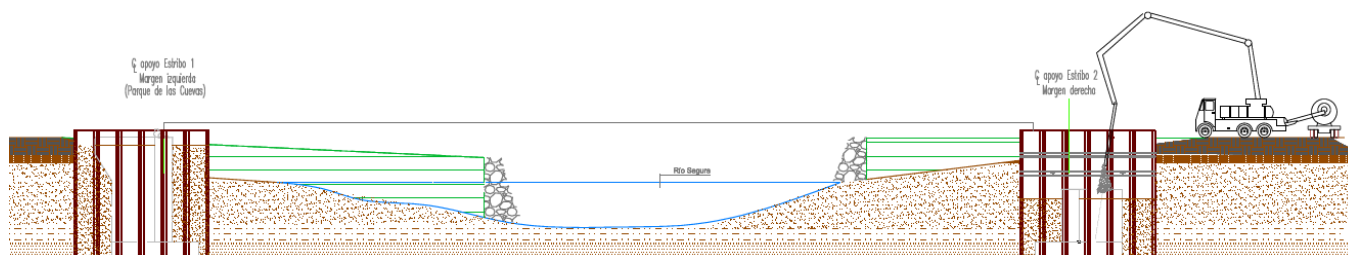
c. Imagen de la construcción de la cimentación y estribos
